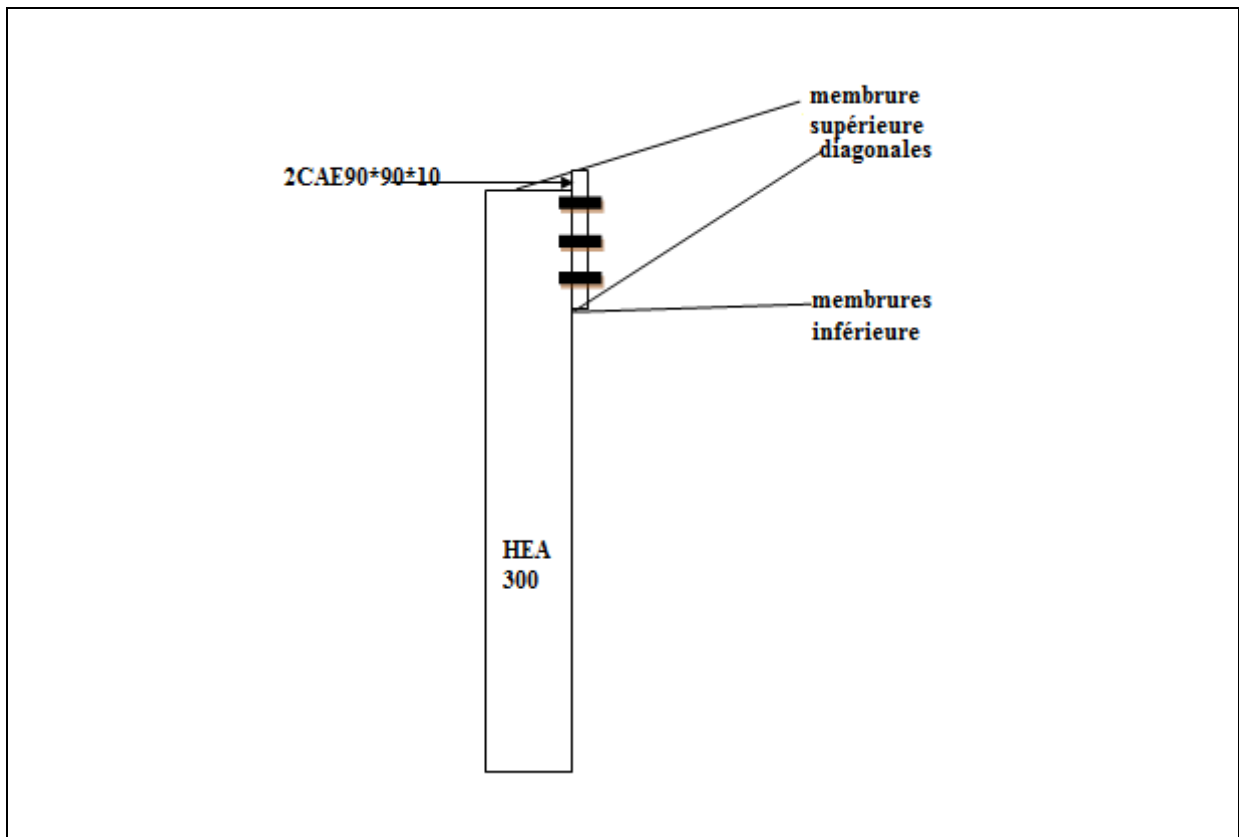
coupe transversale d'assemblage ferme – poteau.
